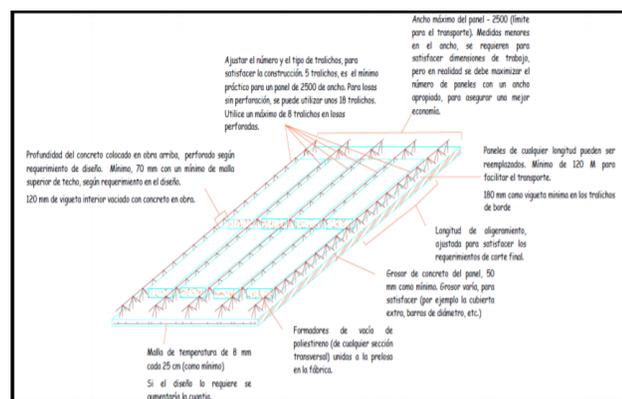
Características de las prelasas Beton Decken Costo-Tiempo. Fuente: Beton
